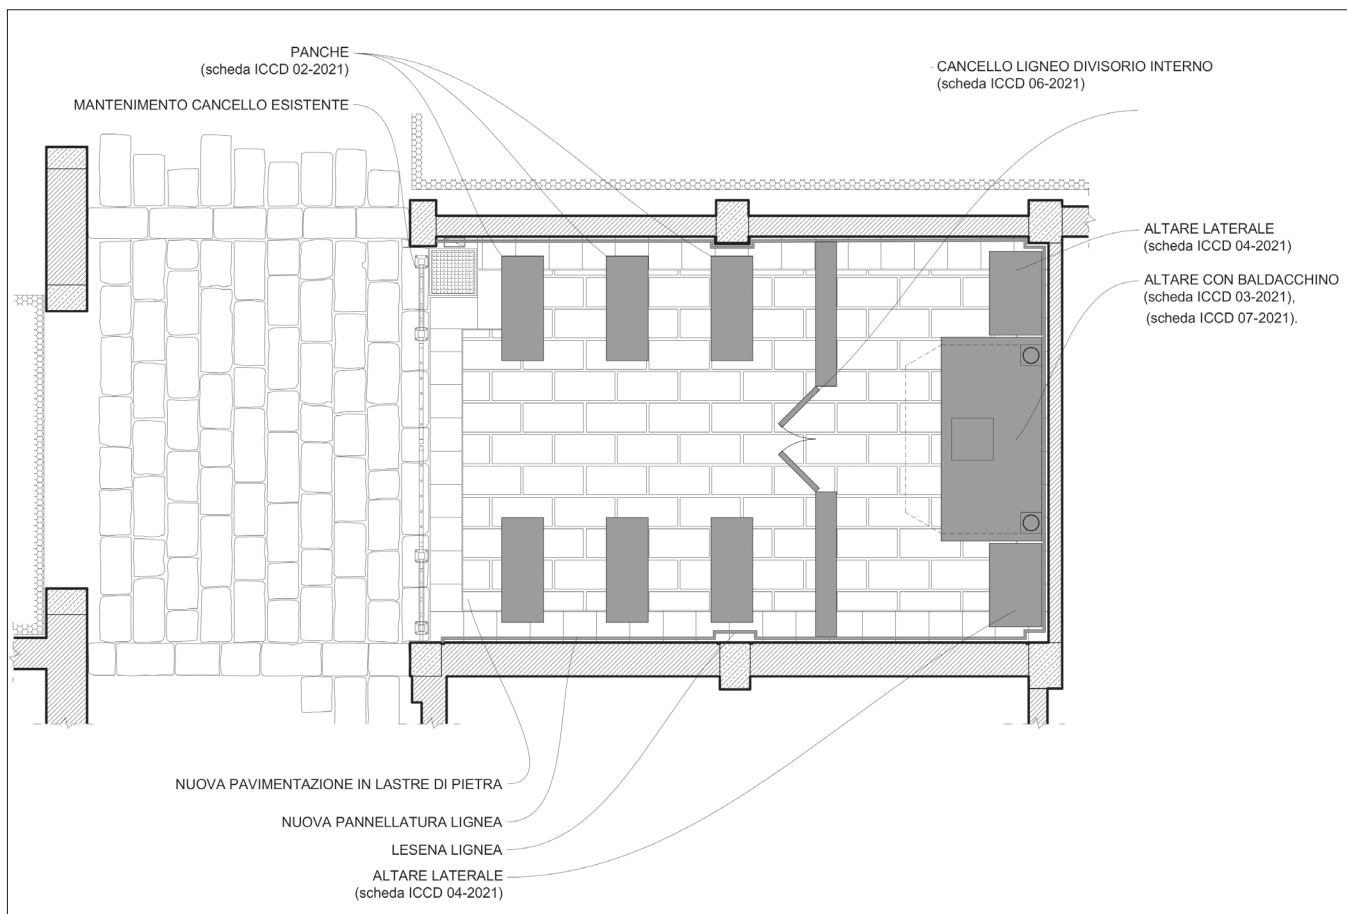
Chiesetta della Madonnina del Granaio. Progetto di restauro e ricomposizione – planimetria (arch. Alberta Baldin)
